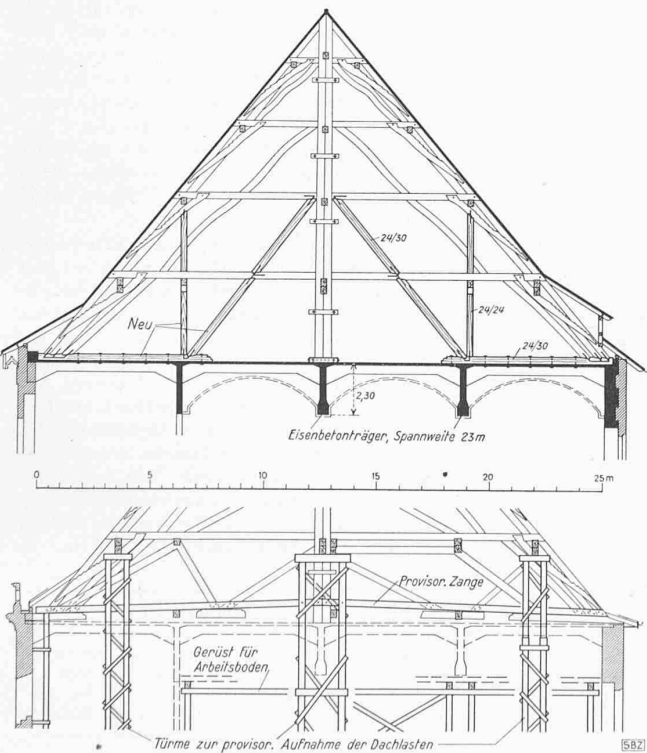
Hilfsgerüste zum Umbau des alten Dachstuhls
